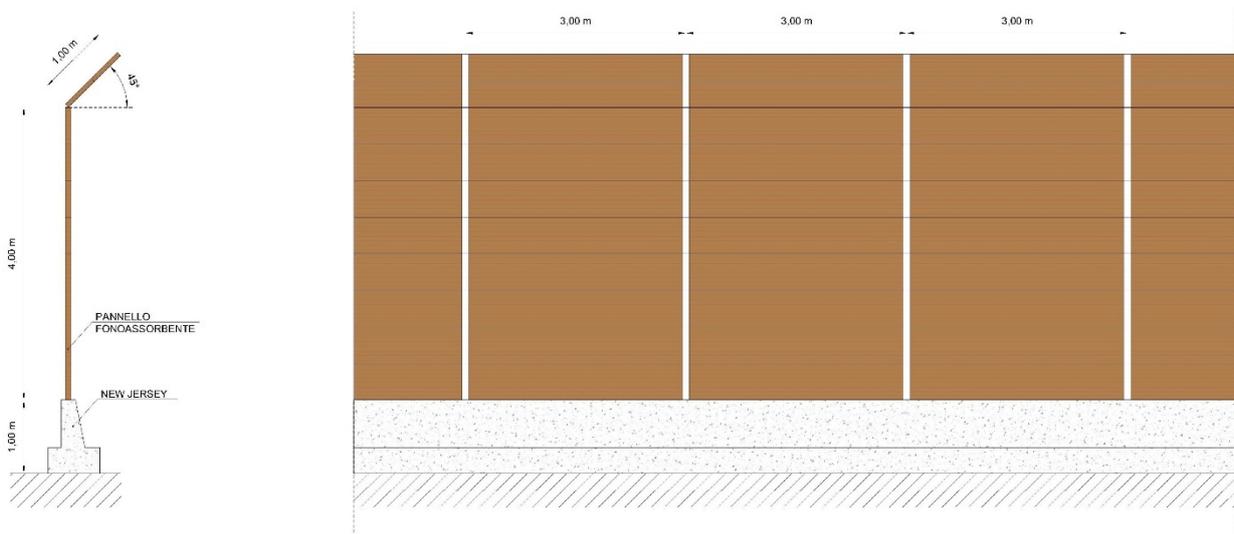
B– Progetto sistemazione pannelli fonoassorbenti
